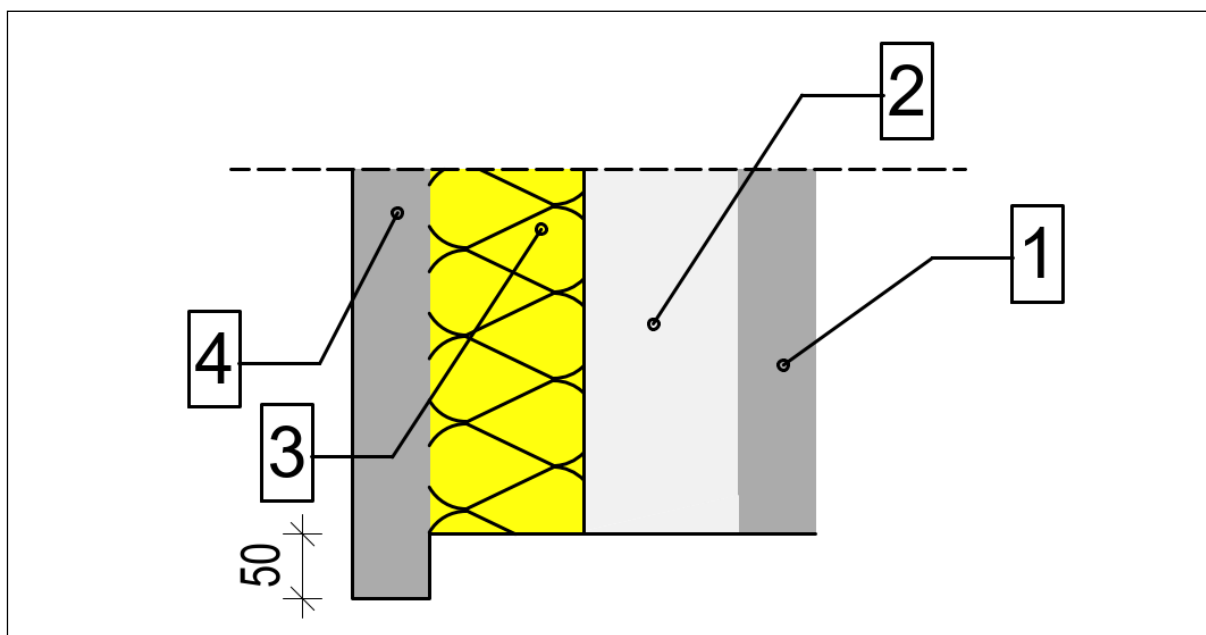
Przekrój przez konstrukcję ściany prefabrykowanej (opis w tekście); źródło: [6]
